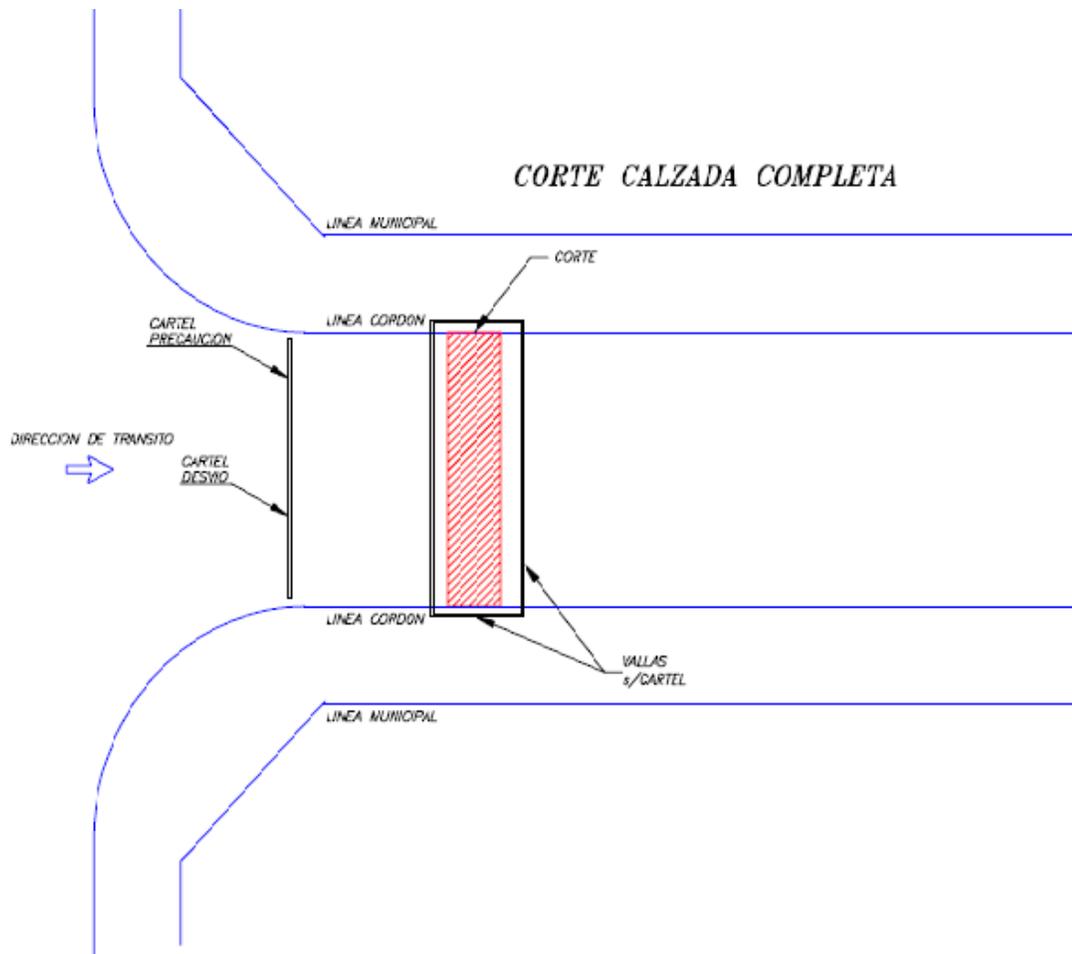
Esquema en planta de un corte de calzada completa.
